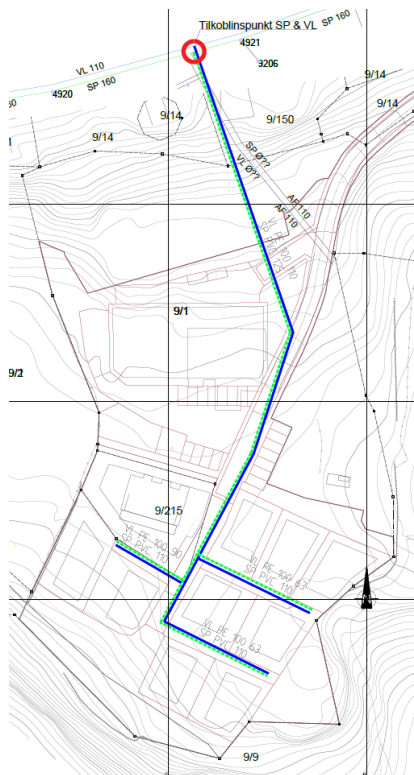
Tilkoblingspunkt til kommunalt VA-anlegg (fra rammeplan VA, Vial as)
